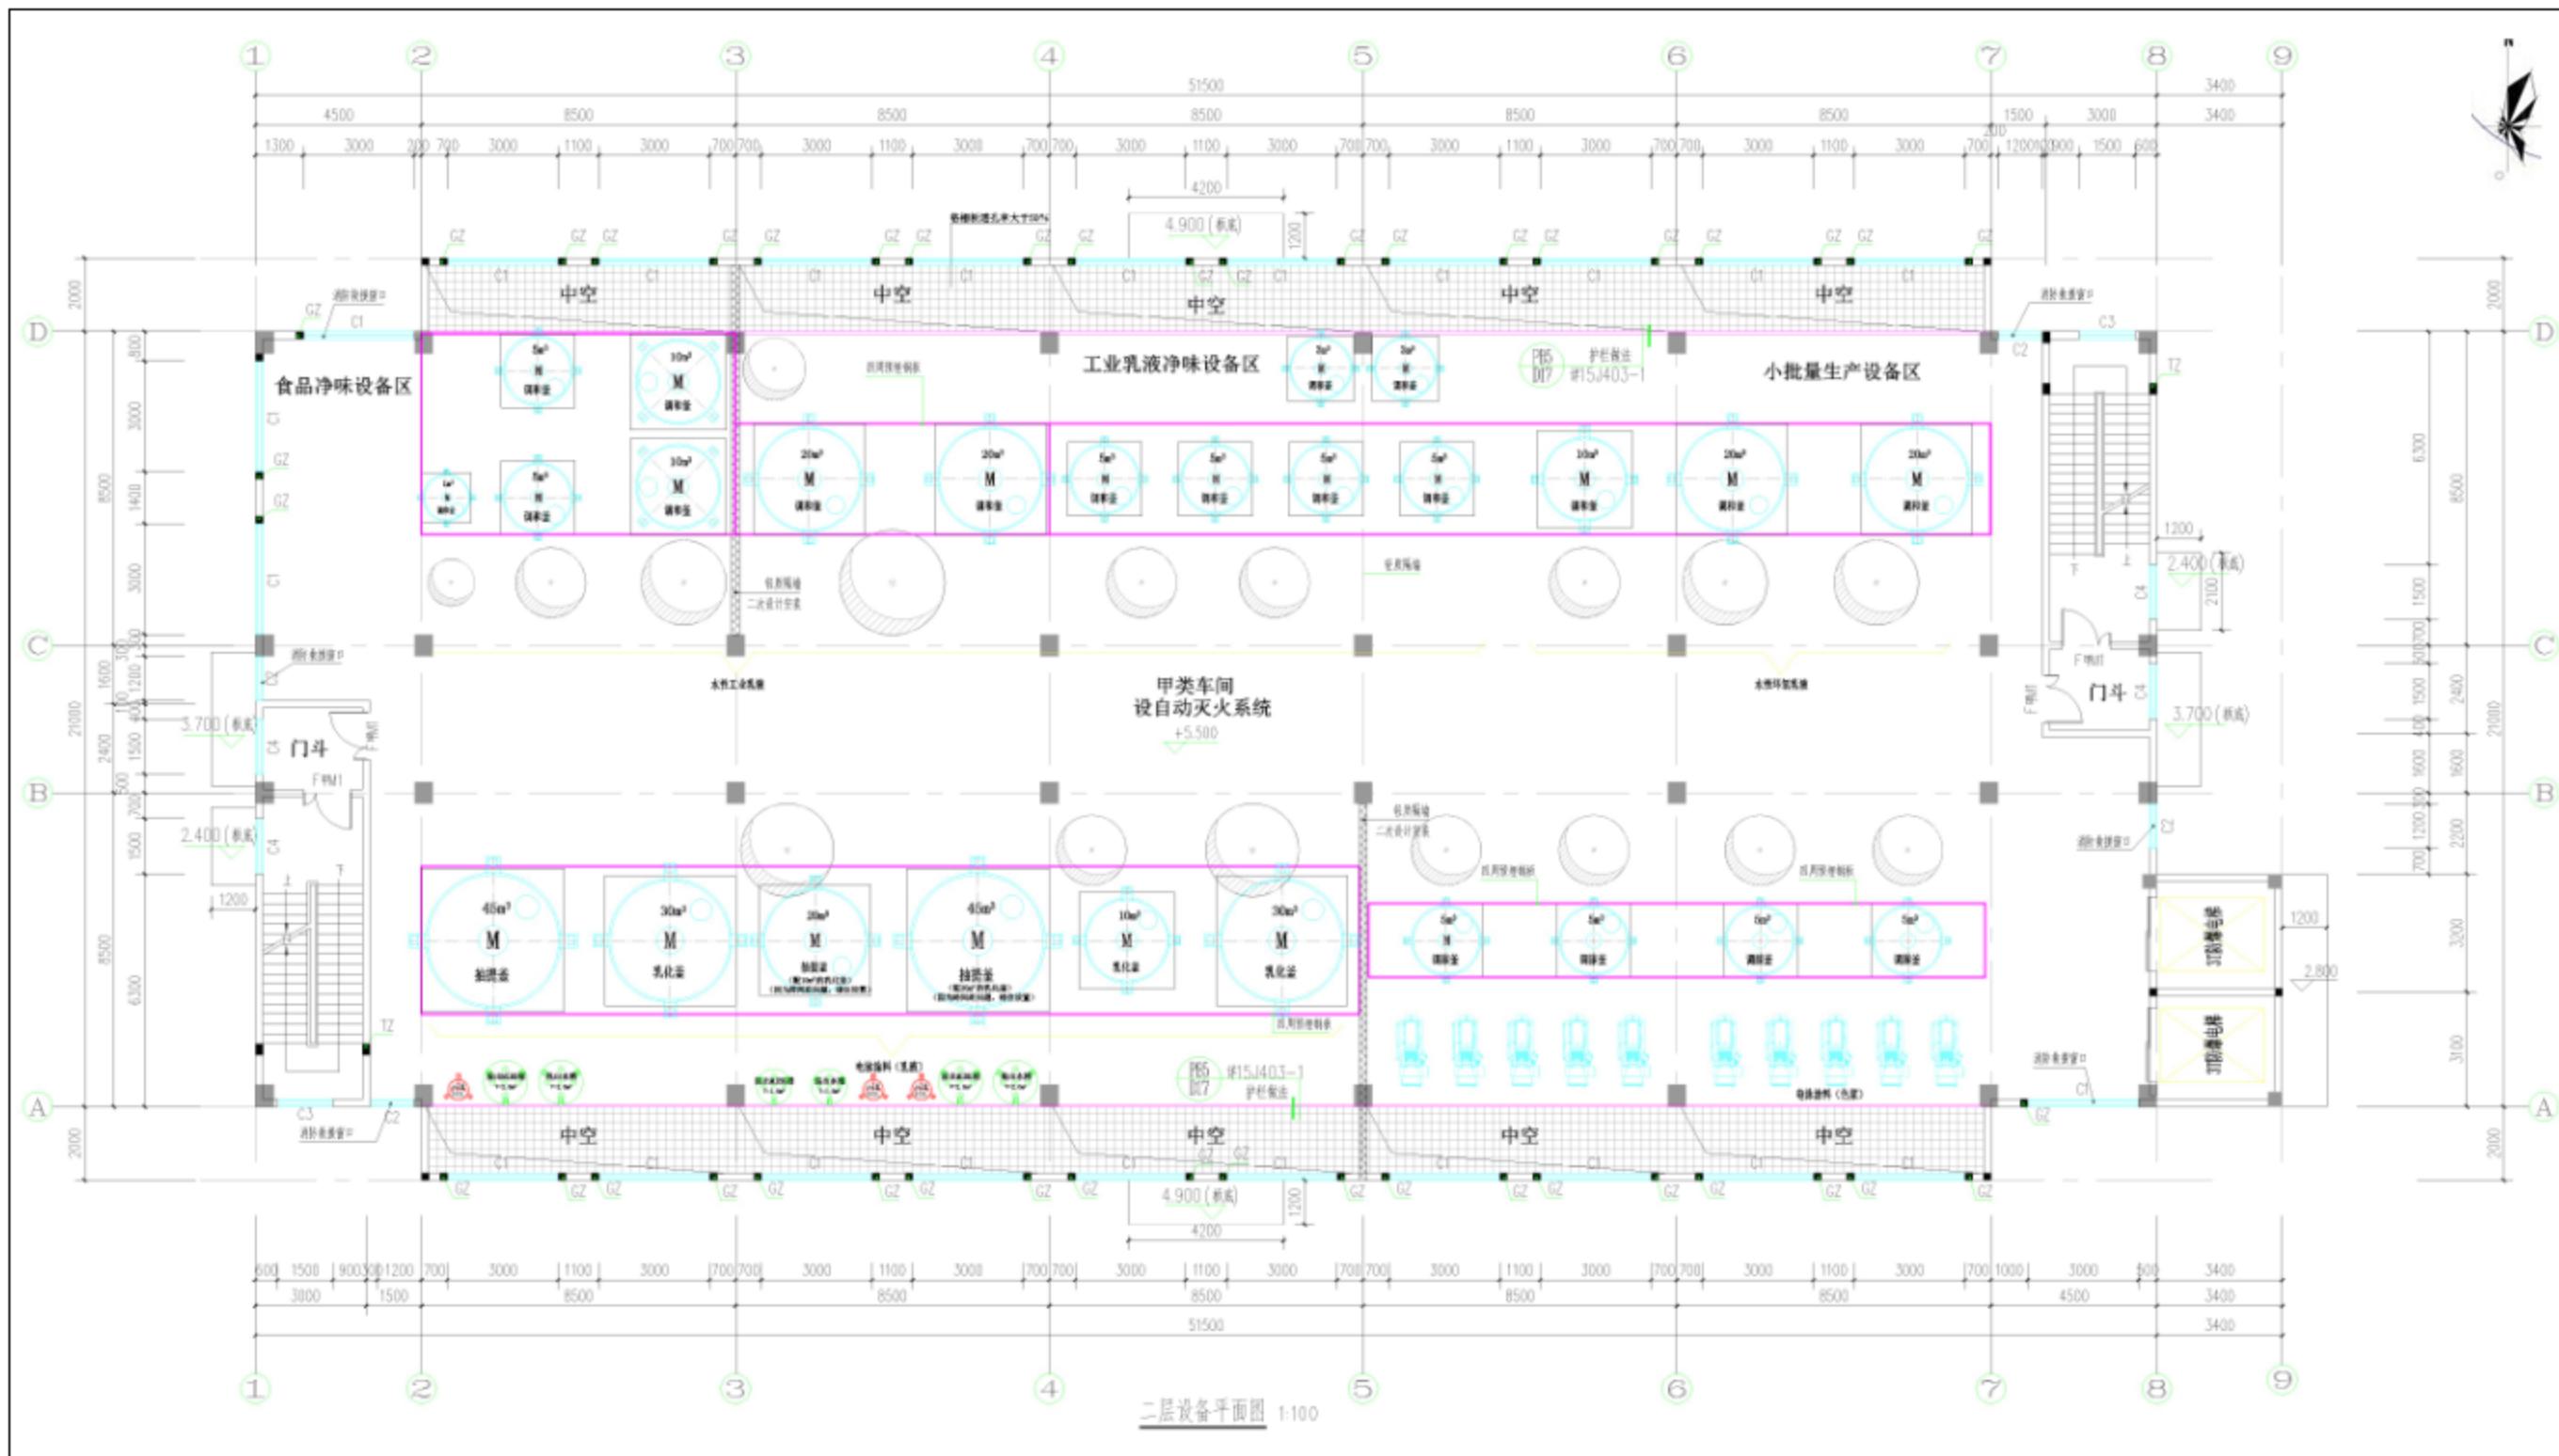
甲类车间C2层平面布置图(比例尺1:100)
